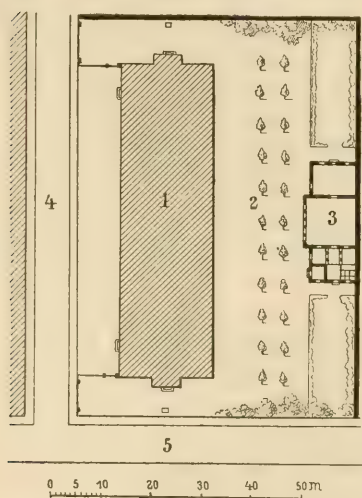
Achtundzwanzigklassiges Schulhaus in München. Situationsplan nach Voit. 1 Schulhaus, 2 Spielplatz, 3 Kindergarten, 4 5 Straßen.
